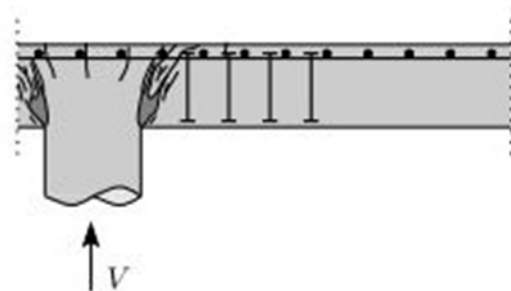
Rotura por esmagamento na zona do pilar, Fernández e Muttoni [31].
